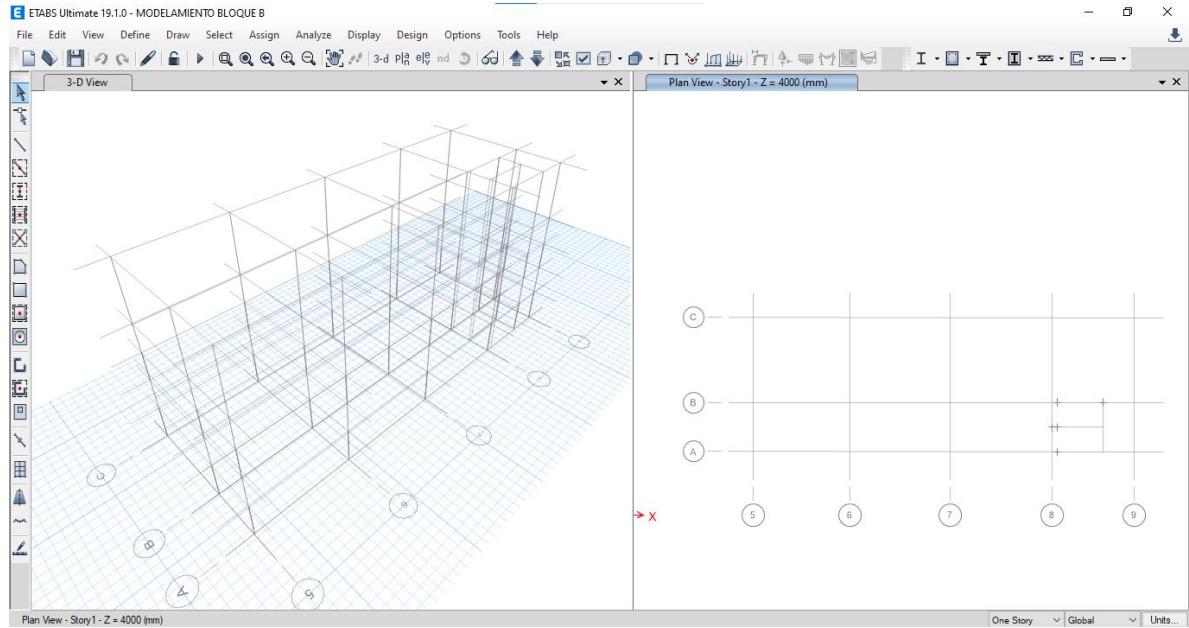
Exportación de grilla en planta y elevación del bloque B
